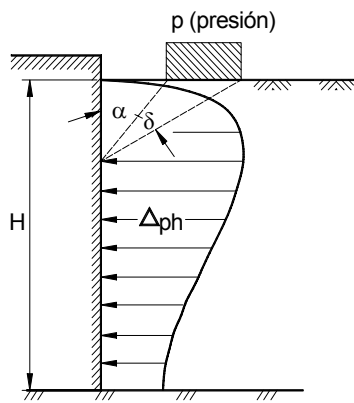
Empuje horizontal sobre un muro provocado por una faja uniformemente cargada
